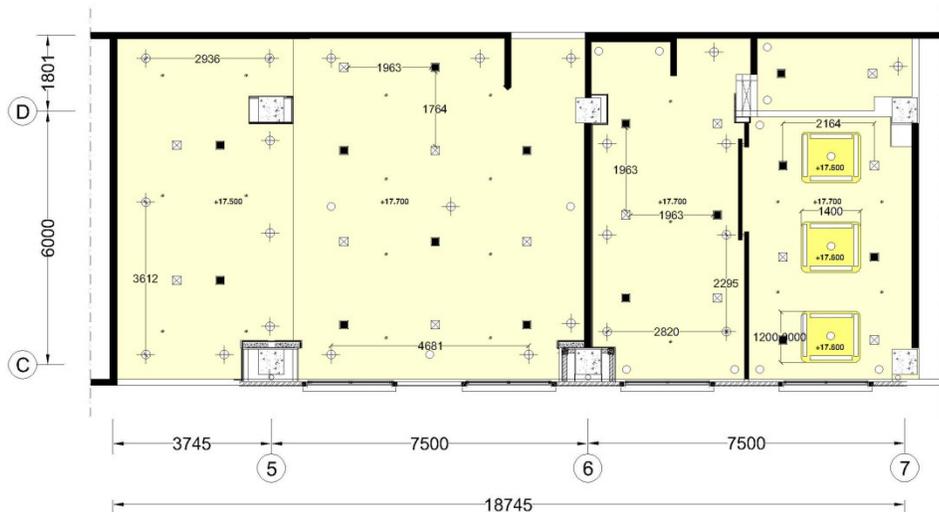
Ruang Terapi Kelompok & Ruang Tenang
